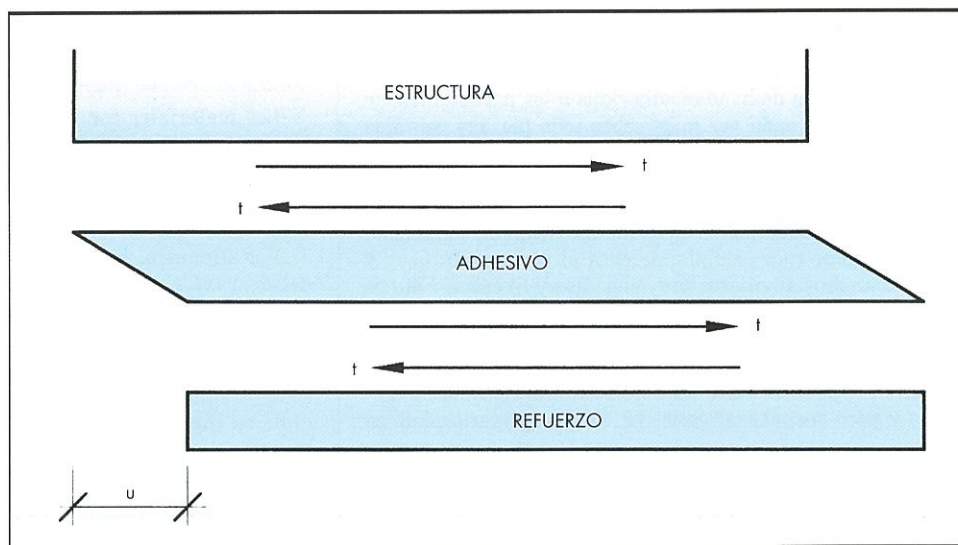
Esquema de la interacción refuerzo-estructura.
